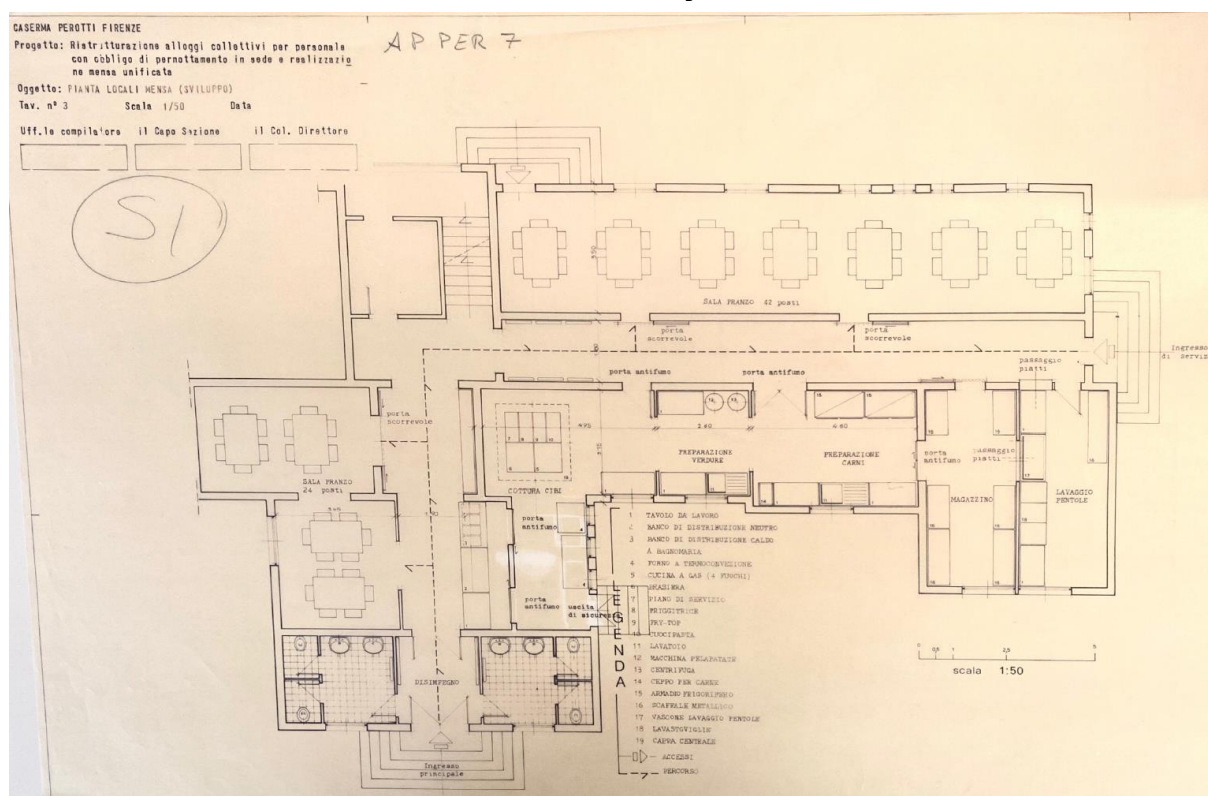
Pianta piano terra - distribuzione con funzione di mensa - progetto.
